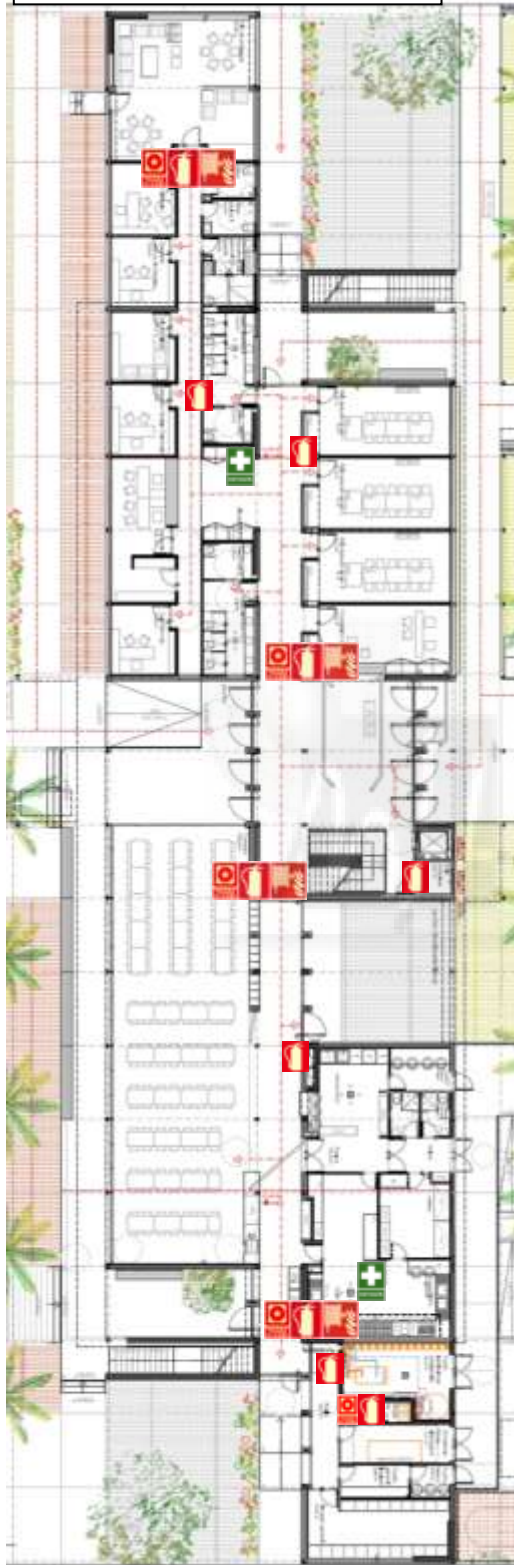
Plano Bloque 3, Planta Baja, BIE, pulsador, extintores y botiquines
